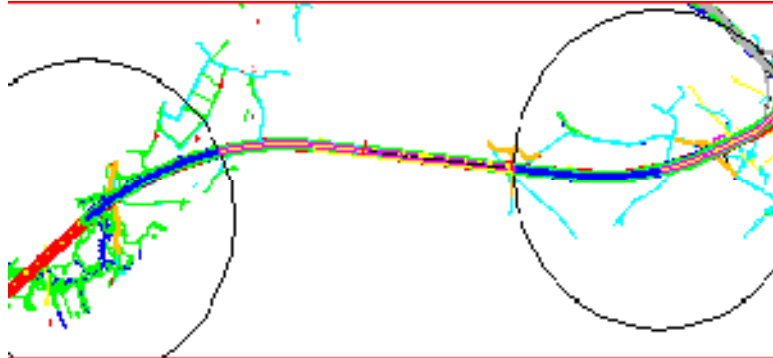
capture d'autocade du tracé en plan qui montre les deux raccordement .
